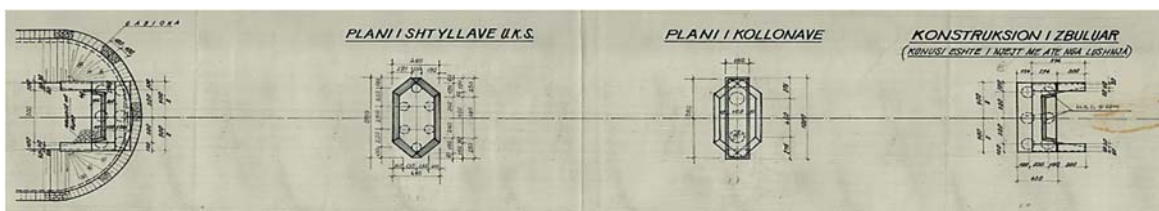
Planimetria. Prerje horizontale në risegën e plintave ([6])
